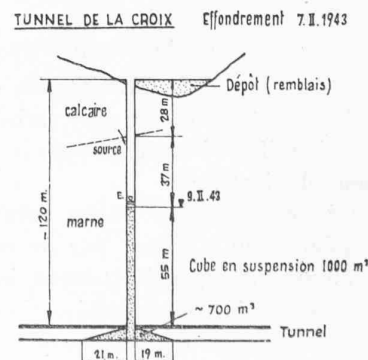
Effondrement du tunnel de la Croix entre Sainte-Ursanne et Courgenay.
